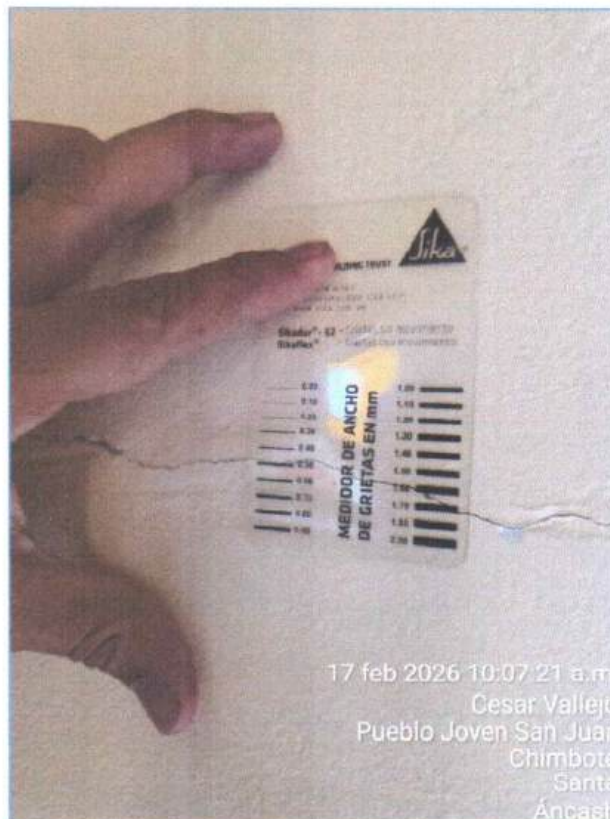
vista de rajaduras en la junta de dilatación en la unión de vigas.
